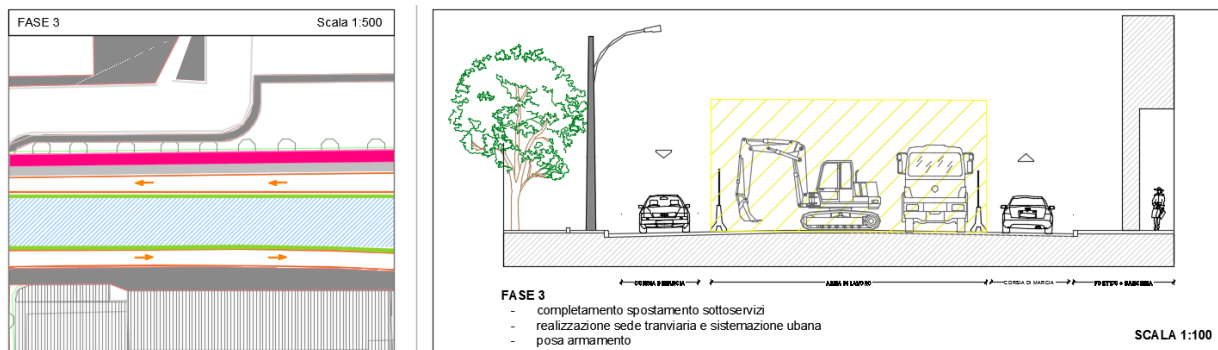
Tipologico cantiere con sede centrale Fase 3
